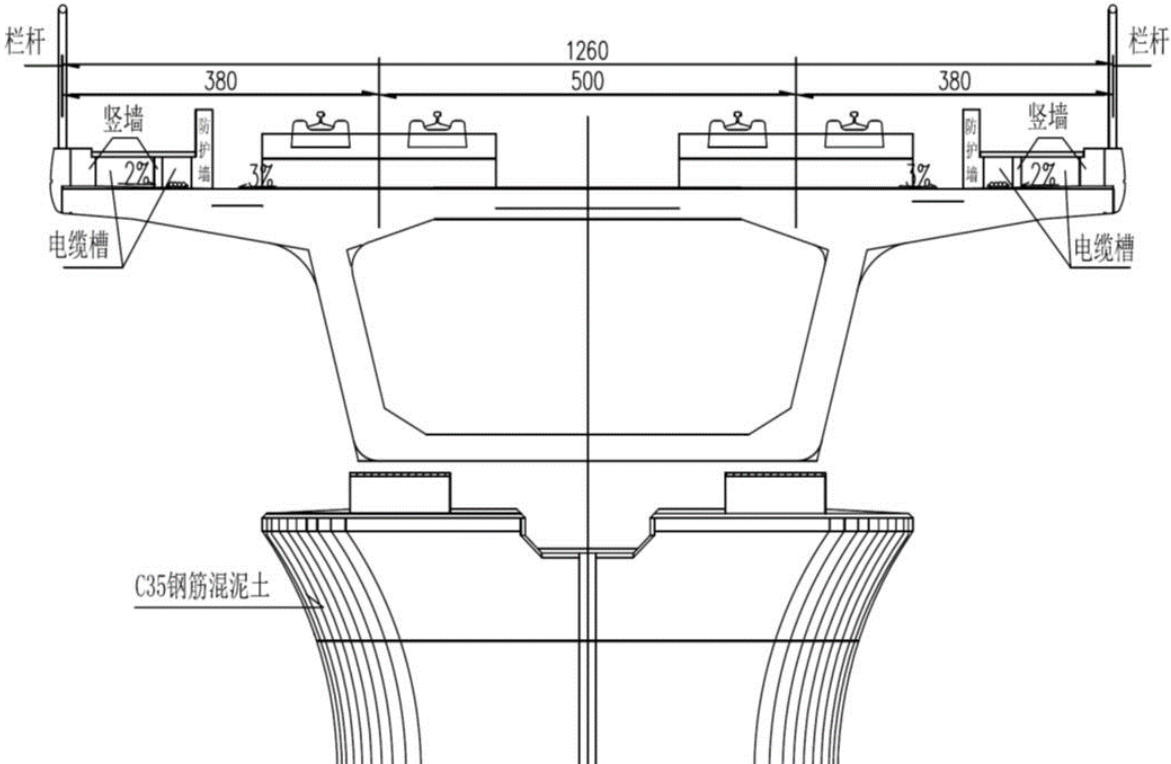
高速铁路（双线）桥梁横断面示意图（单位：cm）
